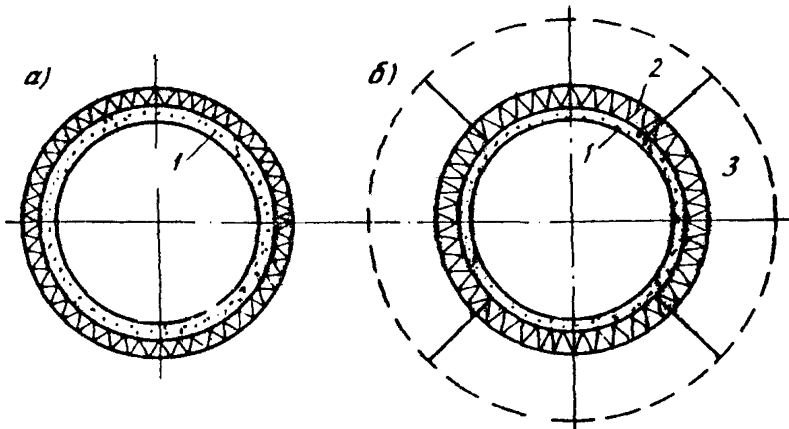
Расчетные схемы набрызг-бетонных обделок: а - двухслойное кольцо; б - трехслойное кольцо; 1 - покрытие из набрызг-бетона; 2 - бетонопородный олои; 3 - несущая породная конструкция, образованная анкерами
